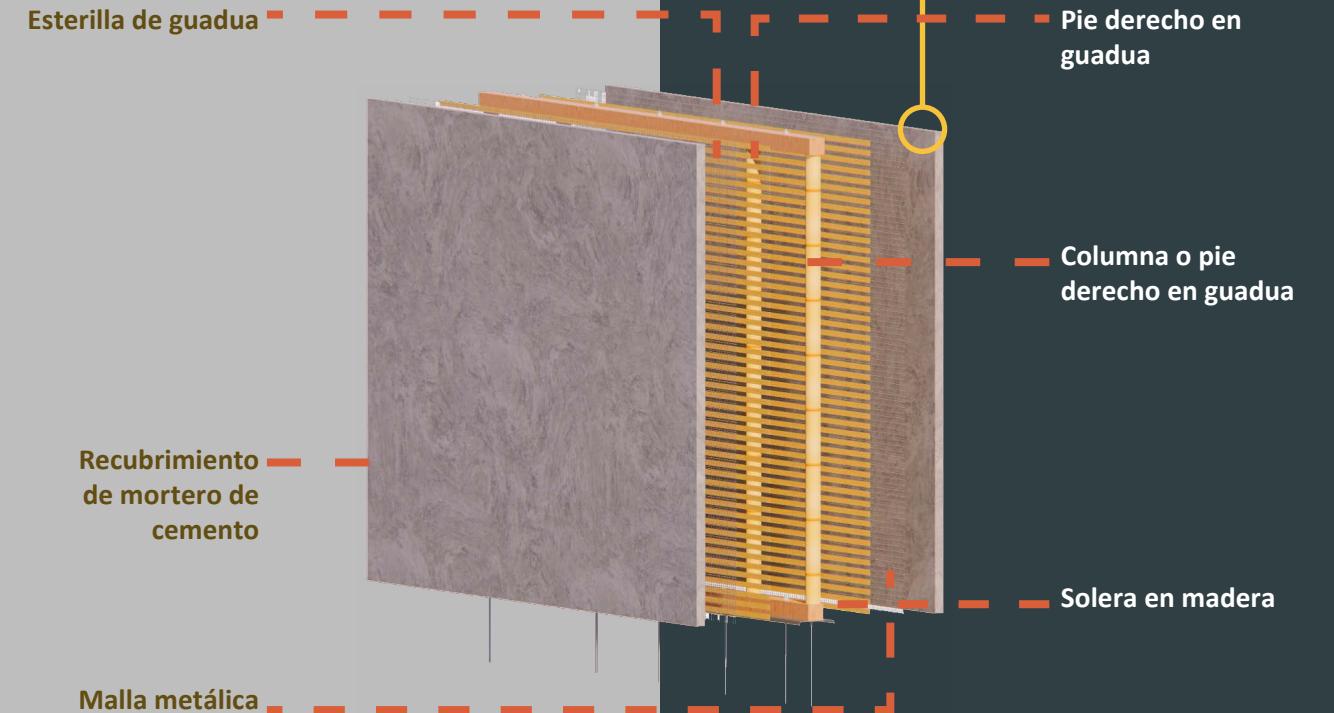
[Figura] Estructura del bahareque encementado. Fuente: Autor.
